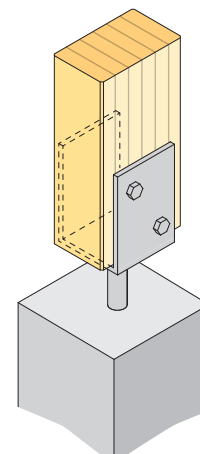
Spikningsplåt på ömse sidor. Fuktskydd mellan limträ och betong.
